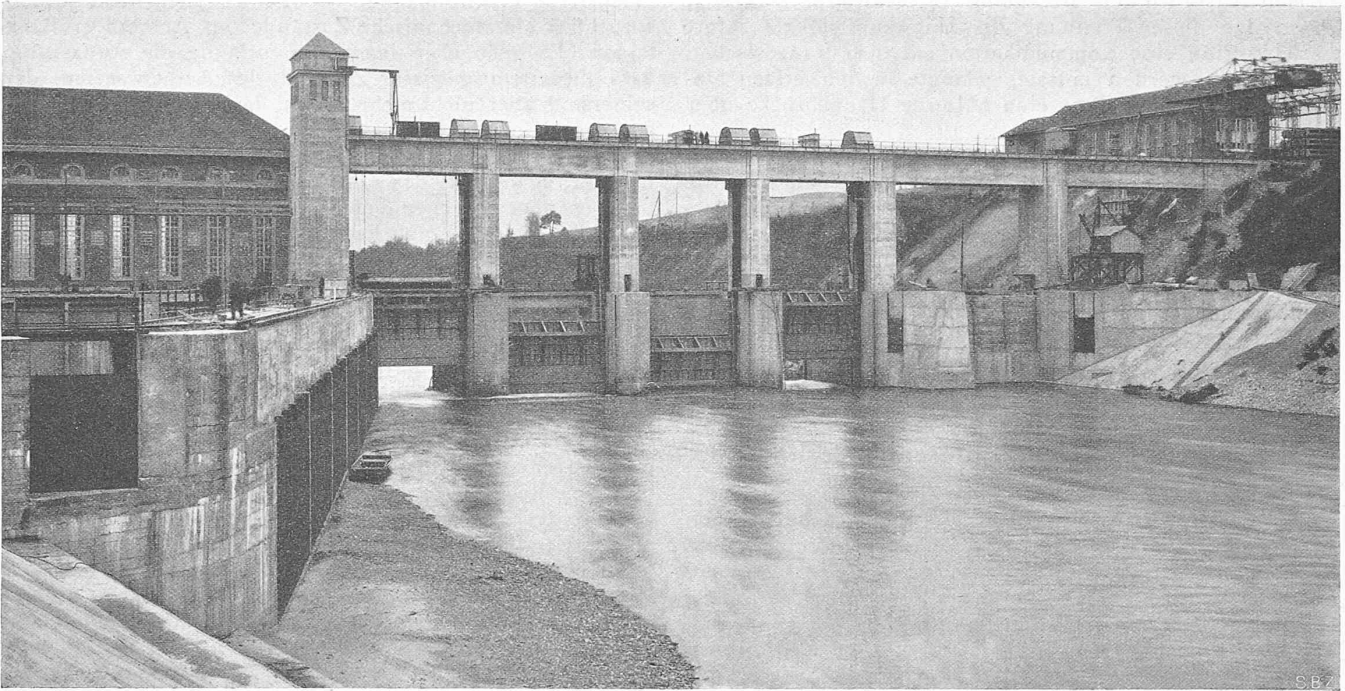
Einlaufbauwerk, Rechen, Steg und Stauwehr, unmittelbar vor dem Einstau.
